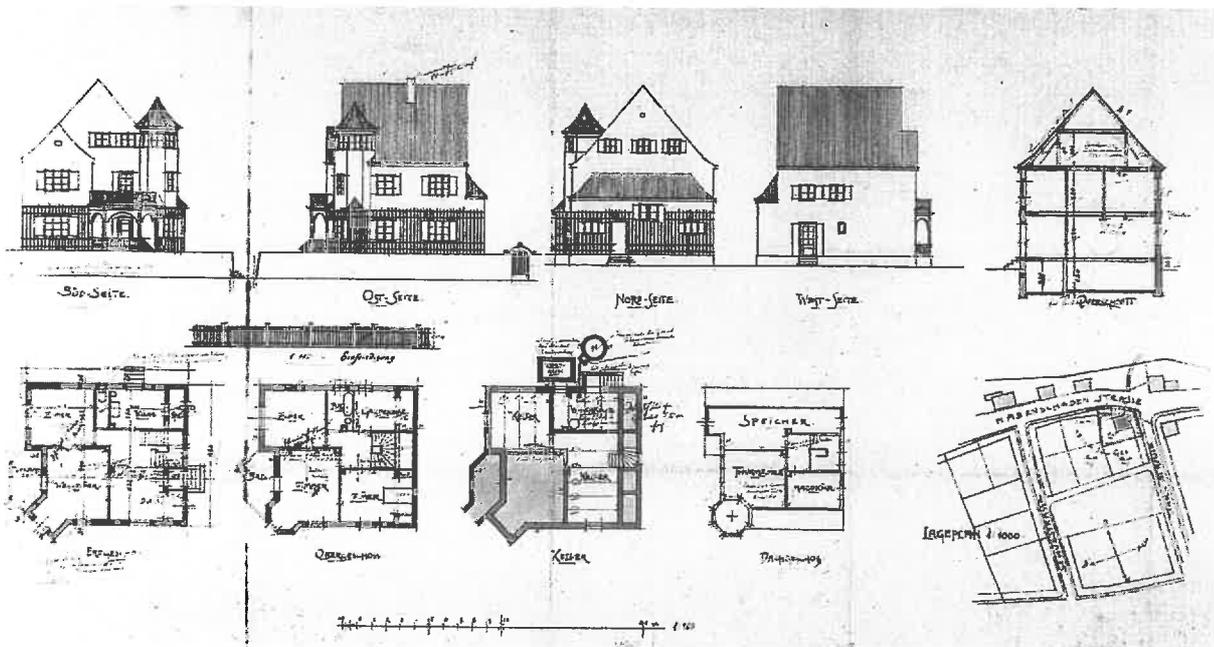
Villa Bauschinger, Habenschadenstraße 14
